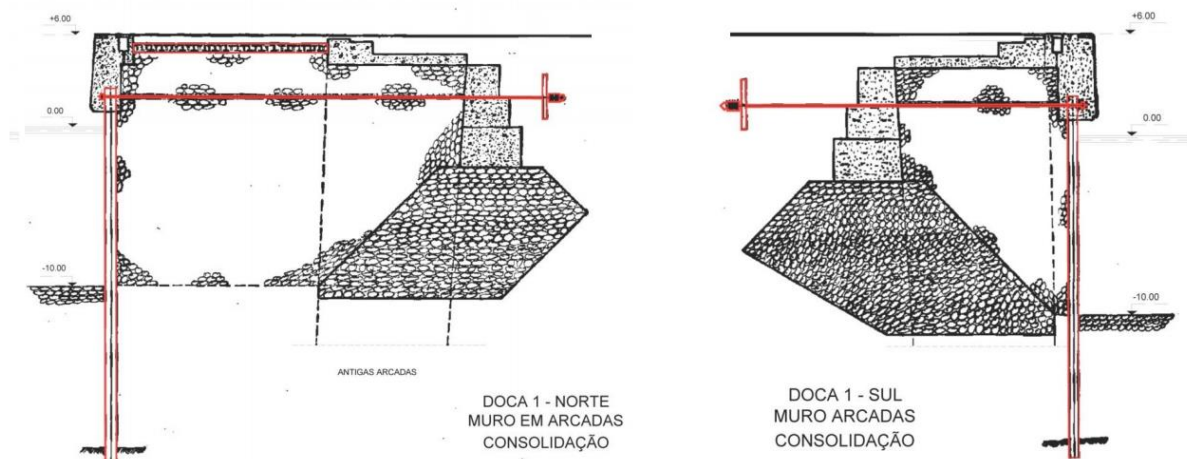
Reparação dos Muros-Cais em Arcadas, da Doca 1 do Porto de Leixões, entre 1973 e 1974 – Fonte: Adaptado APDL, 2015
